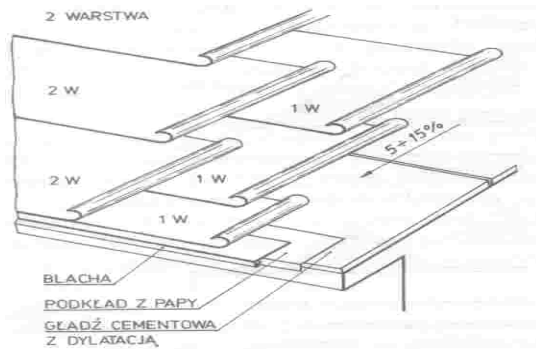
Przyklejanie papy do podkładu betonowego [9, s. 134]
